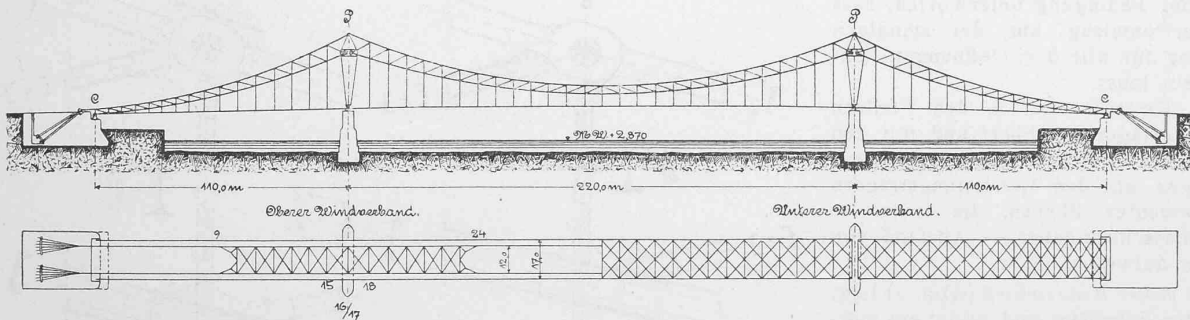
Schematische Darstellung der Hauptträger. — Aufriss und Grundriss. — Masstab 1 : 3000.
